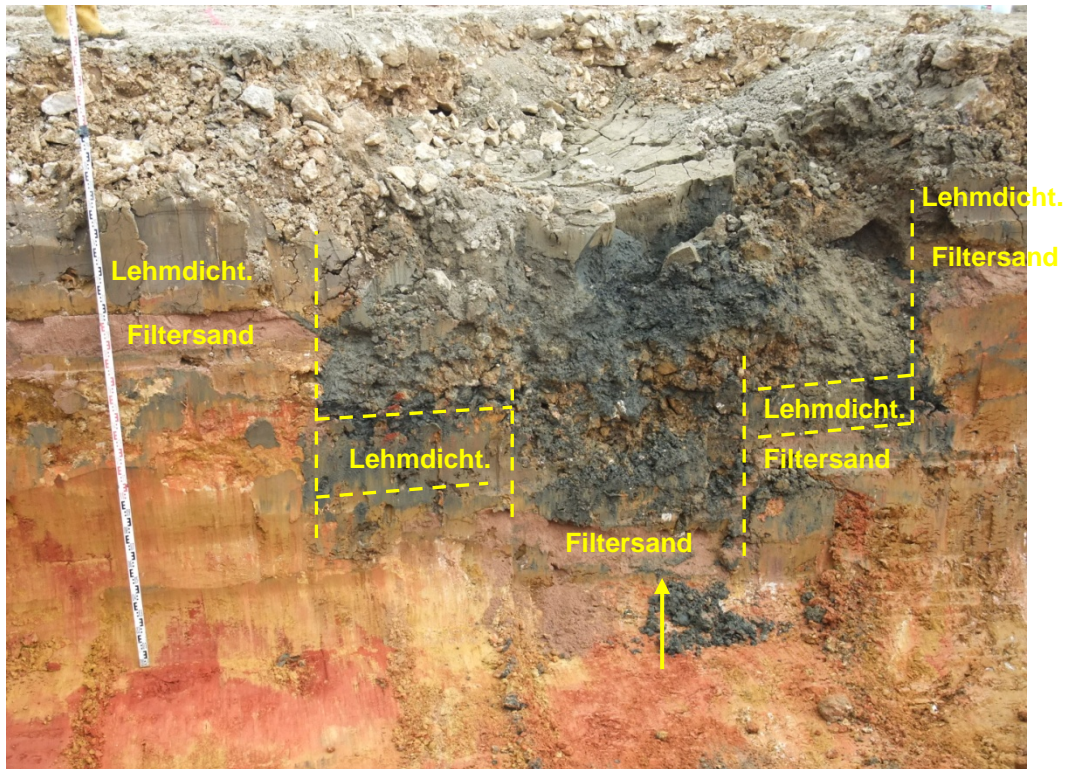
Aushub -3,4 m, Ansicht Einbruchtrichter 3 im Anschnitt (Detail zu Bild 40): abge-sackte Lage Filtersand an der Basis des Einbruchtrichters; Staffelbruch
